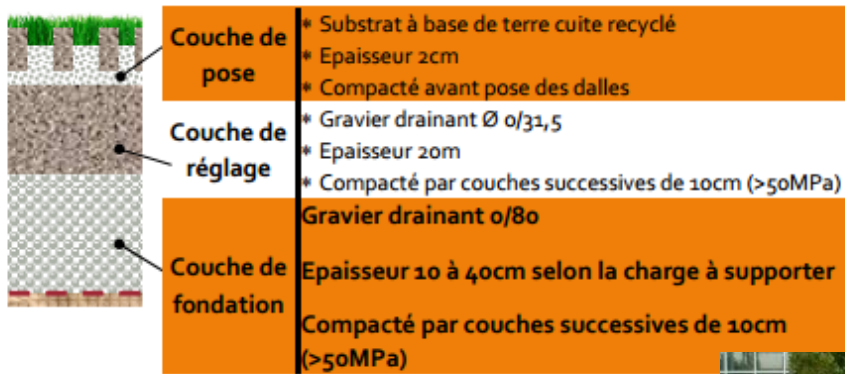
Fondation d'un parking végétal - Source Ecovégétal
